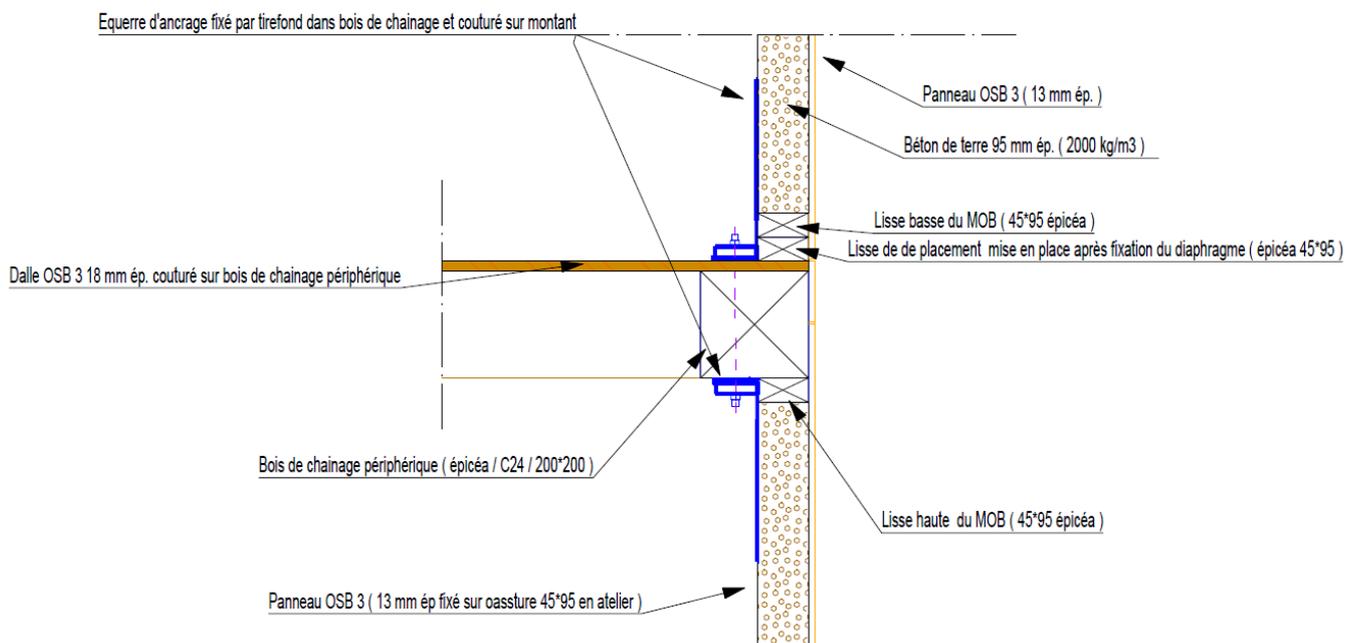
Coupes de principe liaison plancher bois / Mur ossature bois et continuité des tirants – CVT 1 face (extérieur)
